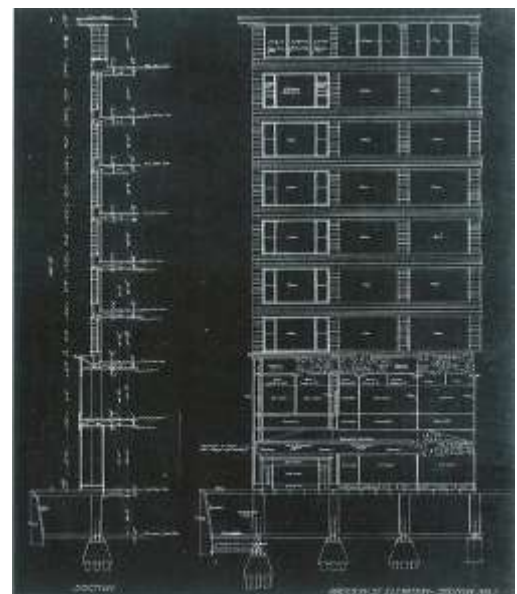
Der. Madison Street Building, Chicago. Sullivan Arquitecto.
